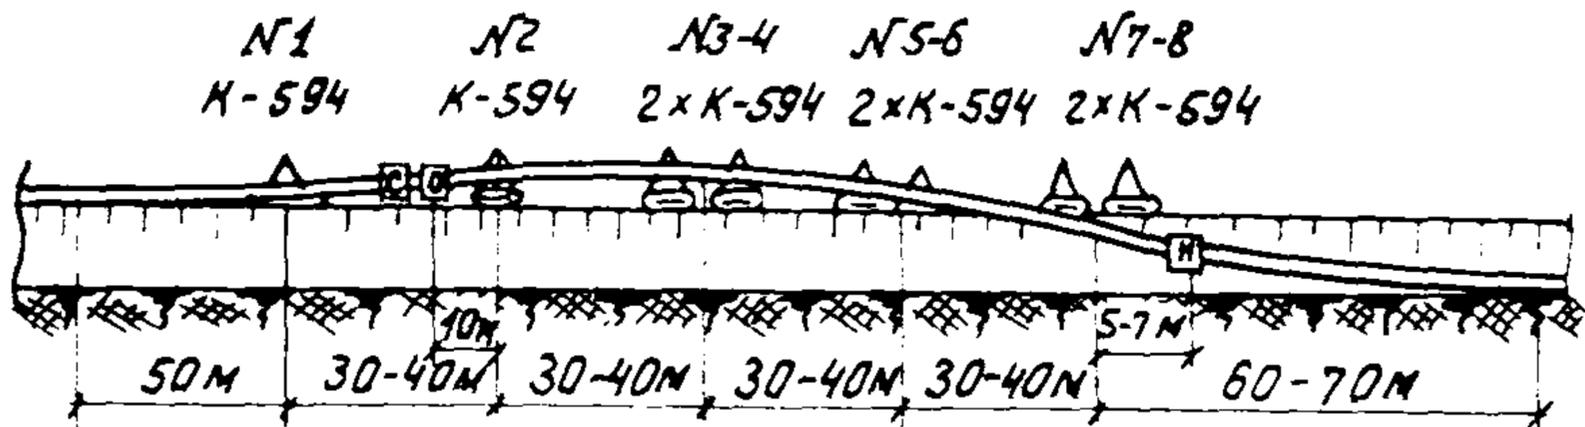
Размещение механизмов в колонне при укладке трубопровода ϕ 1420 мм в условиях неустойчивых грунтов
